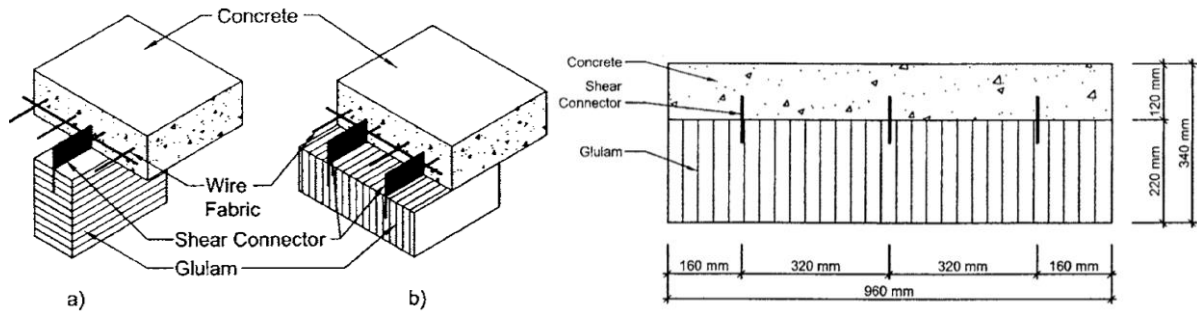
Composants des poutres mixtes bois-béton présentés par CLOUSTON : (a) Poutre en section T, (b) Poutre en plein section [33].
